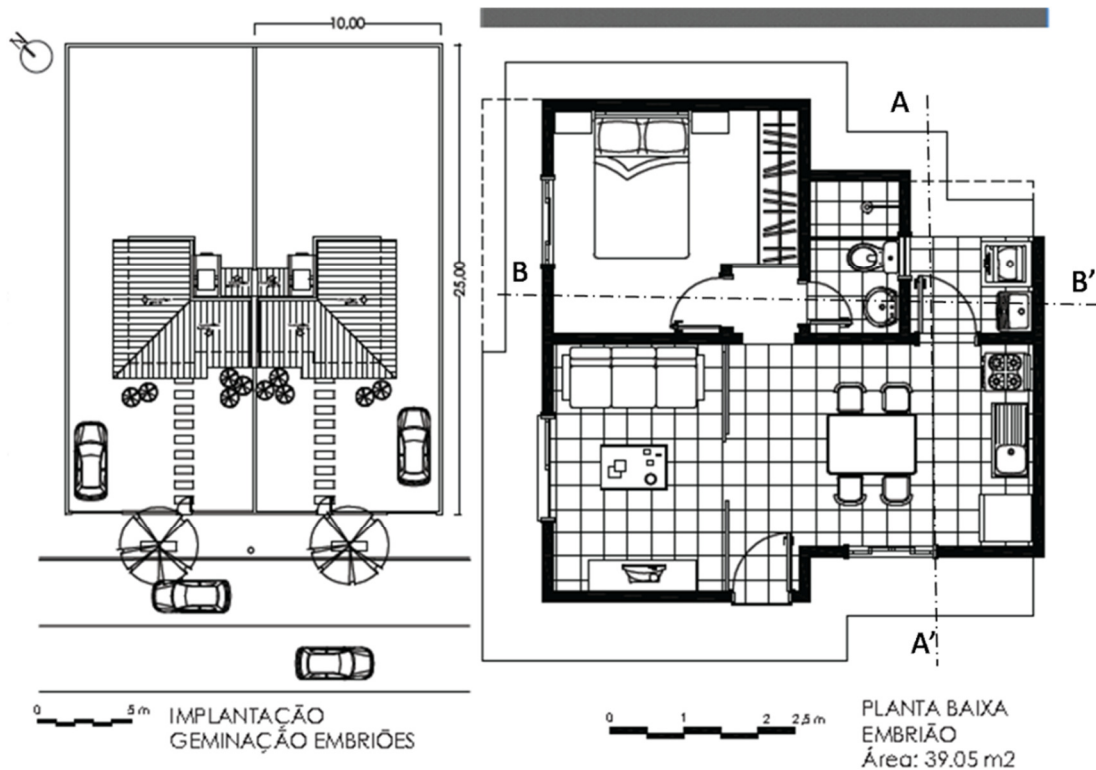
Desenvolvimento do Anteprojeto do embrião-padrão. Planta baixa de implantação das unidades geminadas no lote e planta baixa da unidade básica. Fonte: equipe de projeto.
